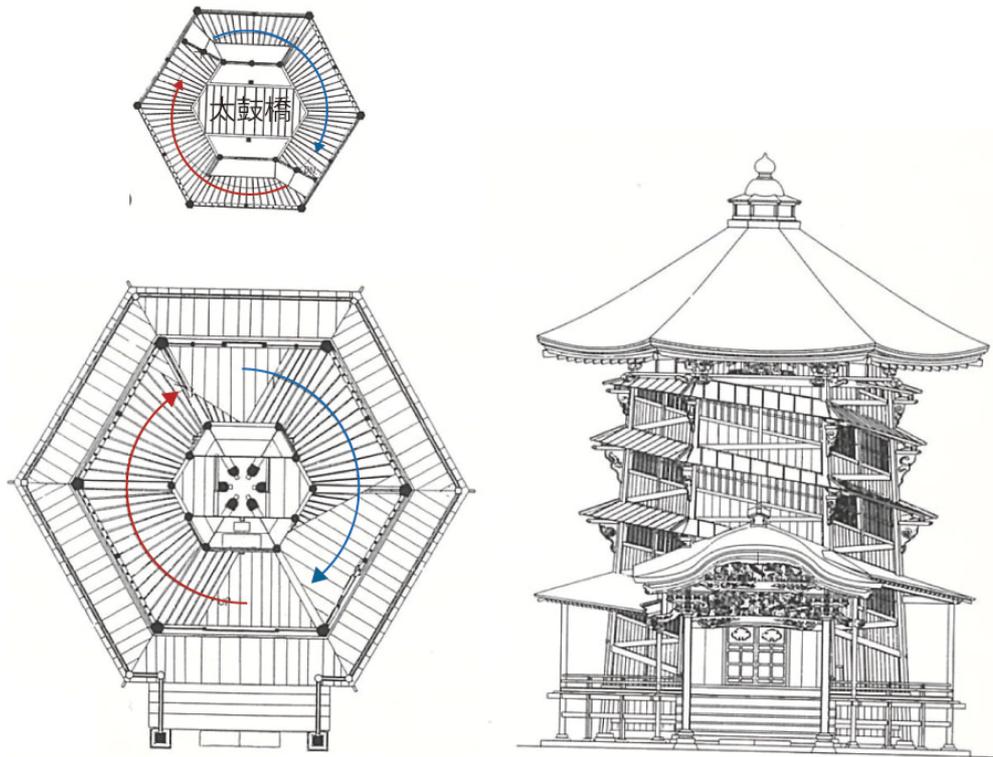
会津若松栄螺堂の平面図・断面図⁸⁾
